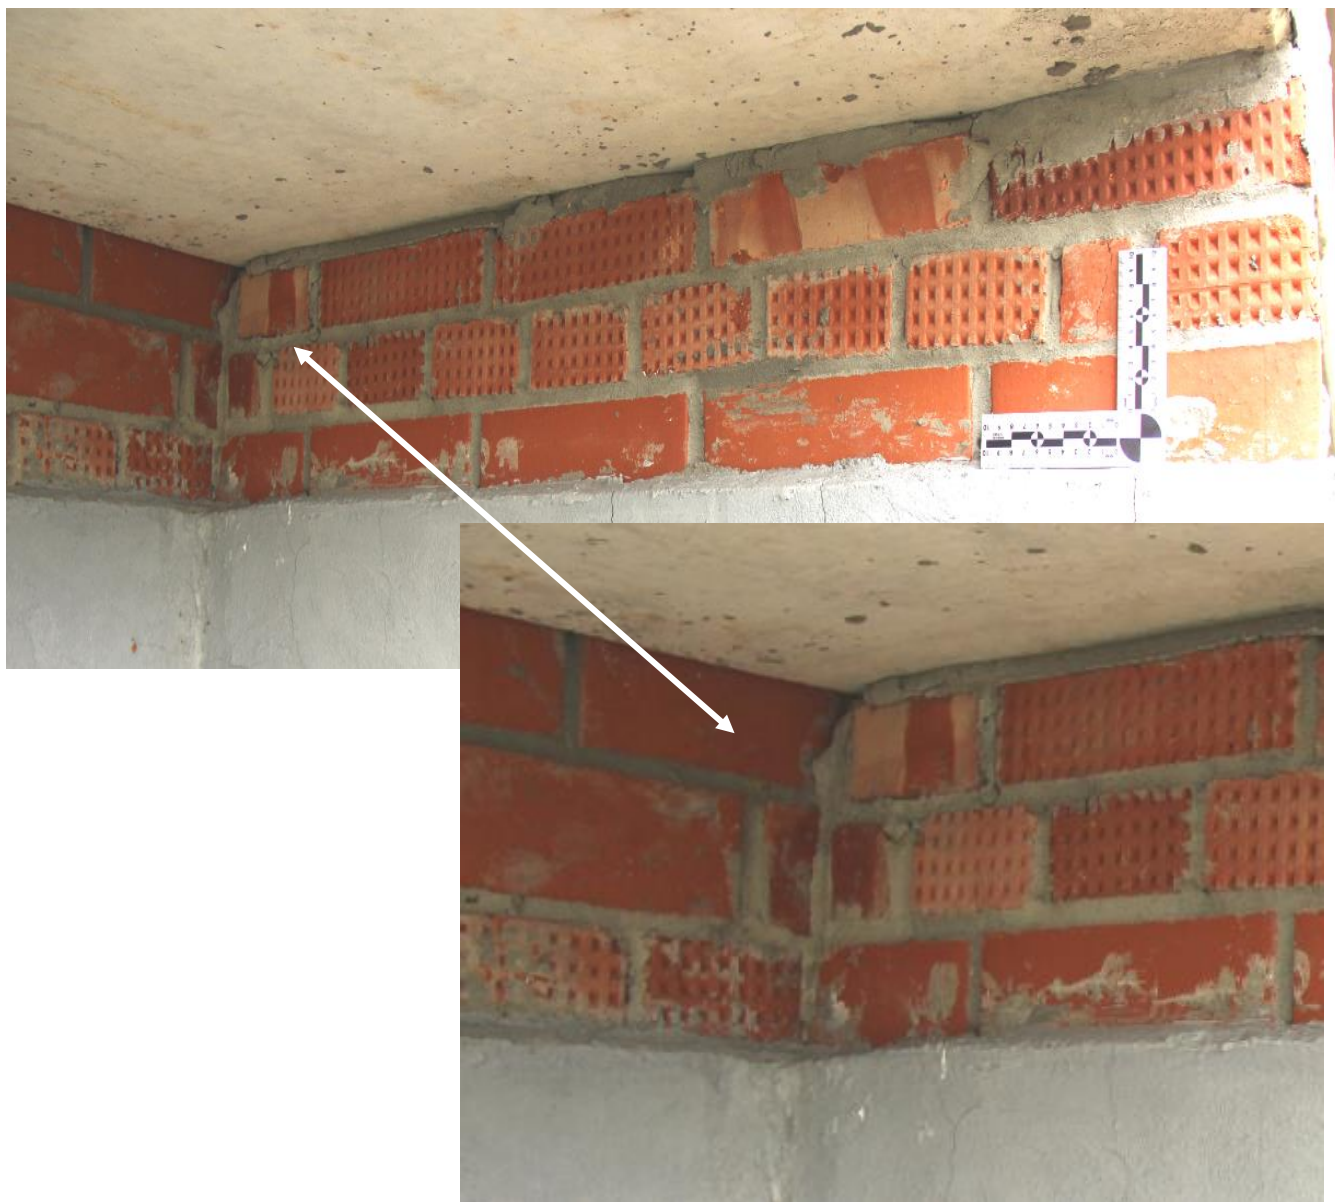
Отсутствие перевязки стенки лоджии с наружной стеной дома №24/3.
